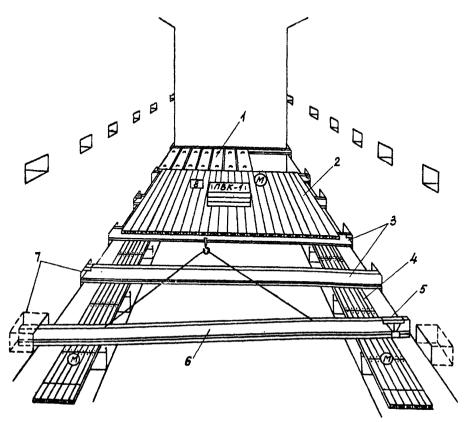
Схема организации работ по монтаху участка перекрития из железобетонных балок ОБТ с протезами ПР-1 и мехбалочным заподнением из плит ПВК-1;
